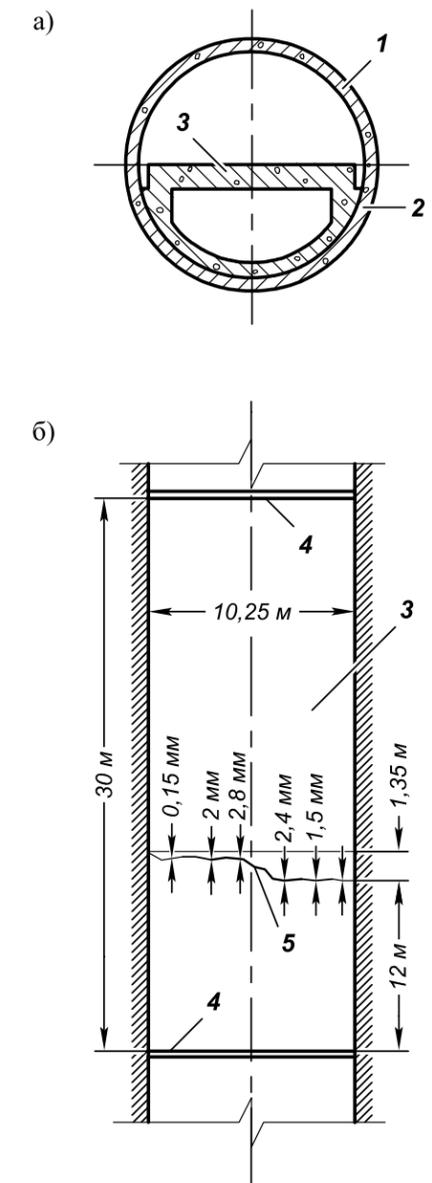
Принципиальная схема плиты проезжей части тоннеля: а — поперечное сечение тоннеля; б — плита проезжей части, вид сверху; 1 — сборная обделка; 2 — опорная конструкция из монолитного бетона; 3 — железобетонная плита проезжей части; 4 — деформационные швы; 5 — трещина, образовавшаяся после бетонирования плиты
